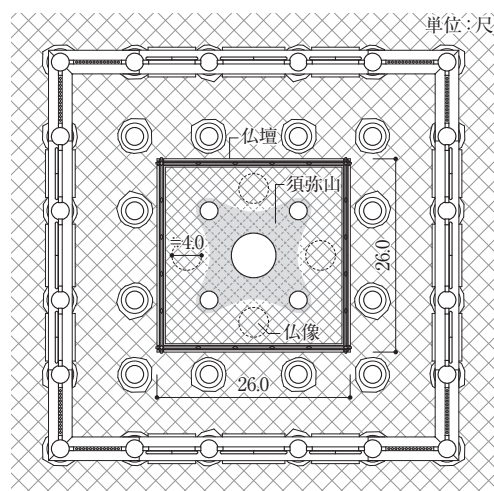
天平塔 初重内部平面図 1 : 300
